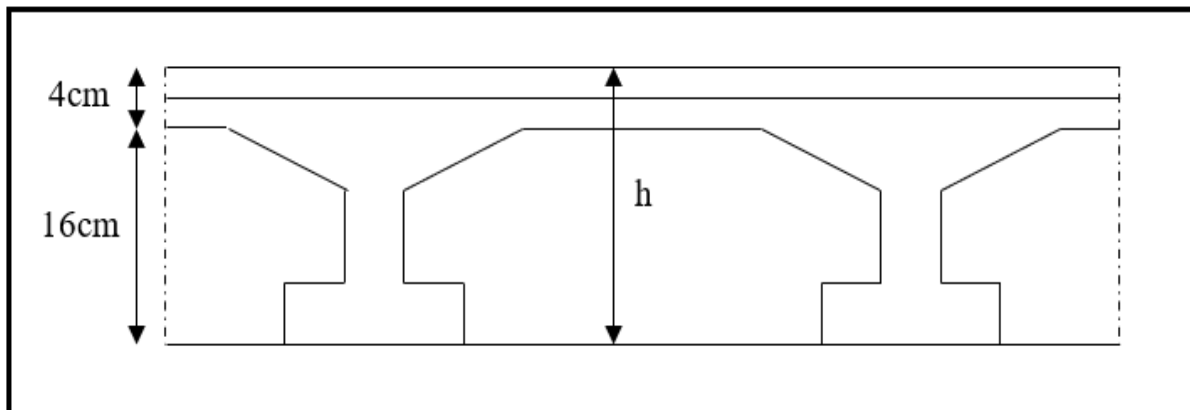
Coupe verticale d'un plancher à corps creux
